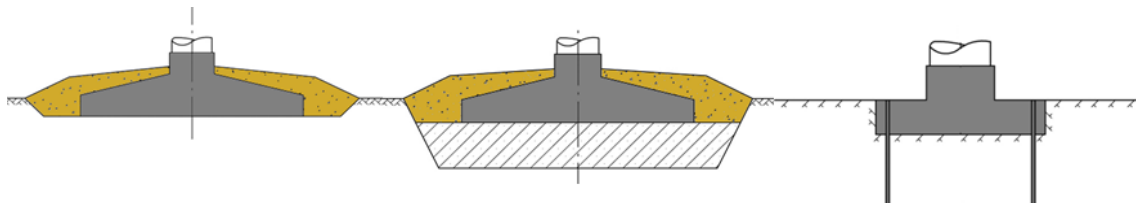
Principbilder över en grund av armerad betong på mark (till vänster) eller på en grund av armerad betong med massabyte (i mitten) samt en bergsförankrad grund av armerad betong (till höger).
